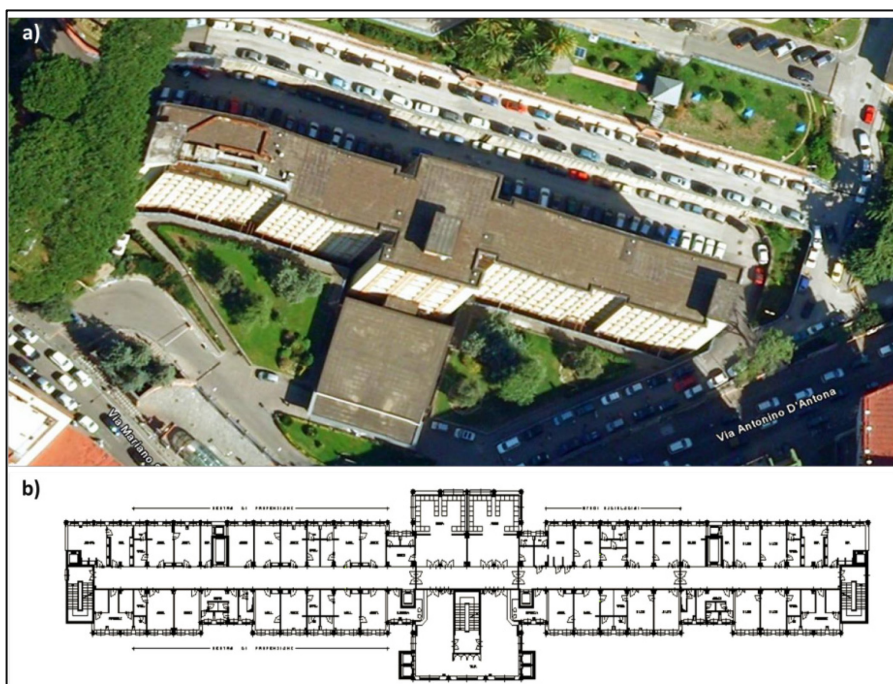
Day-Hospital: a) vista completa dell'edificio; b) pianta del piano tipo.
